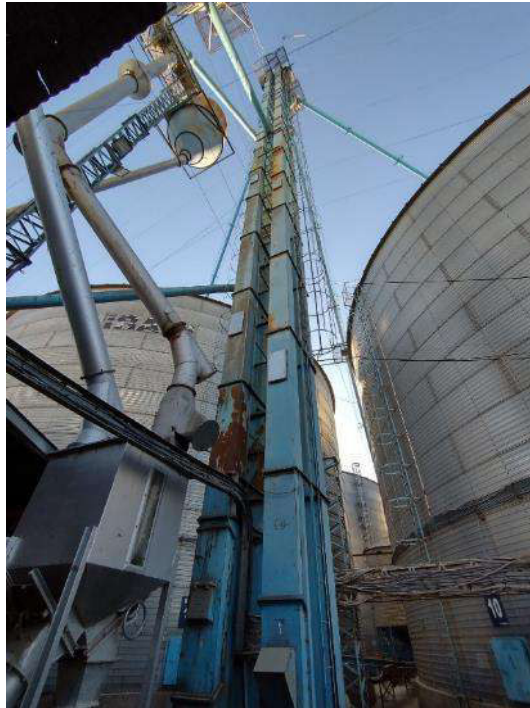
Vista ciclón de noria y silo de descarte Planta 3.
